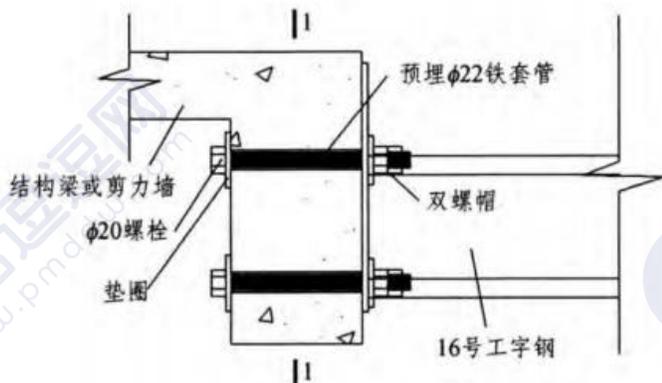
悬挑钢梁与建筑物连接构造（一）
